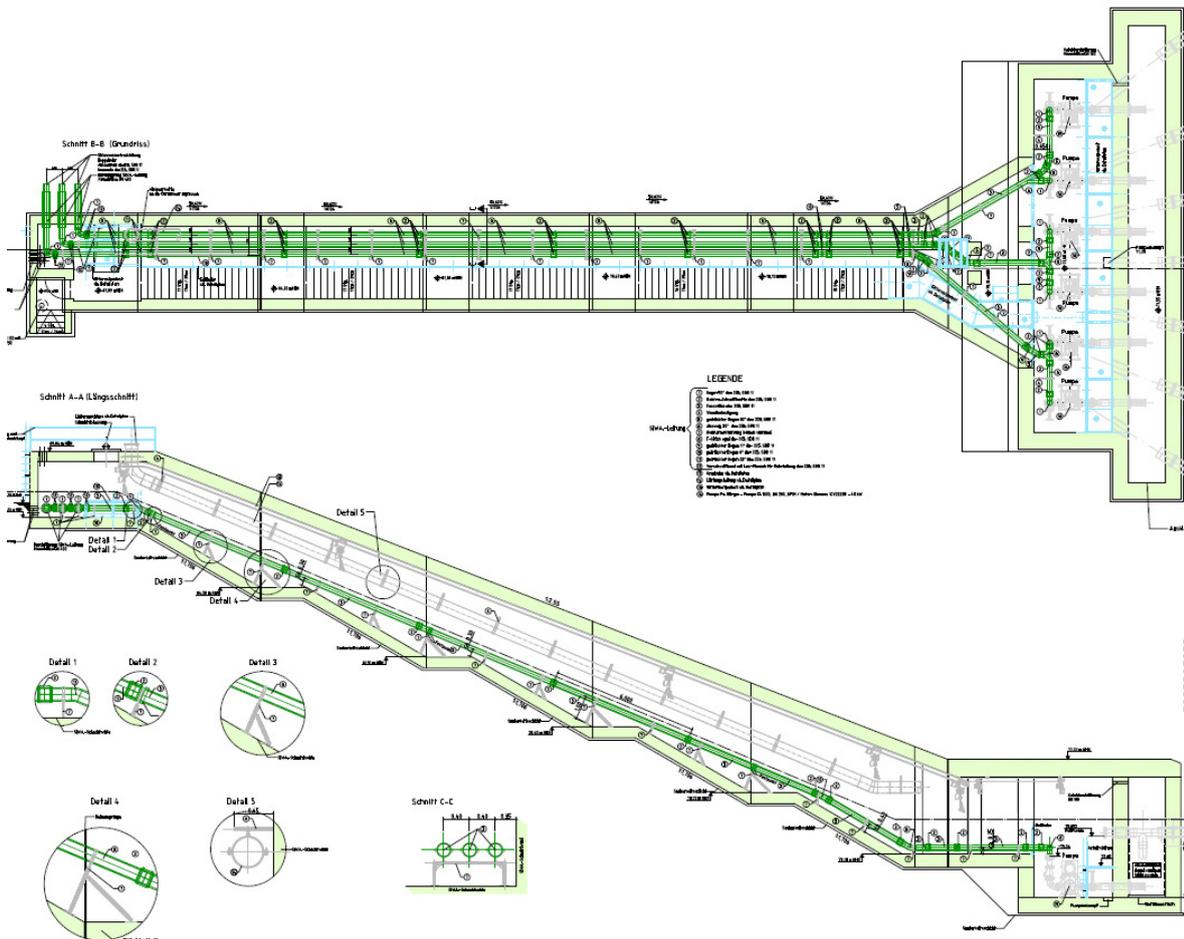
Sickerwasserschrägschacht West, Grundriss und Längsschnitt
